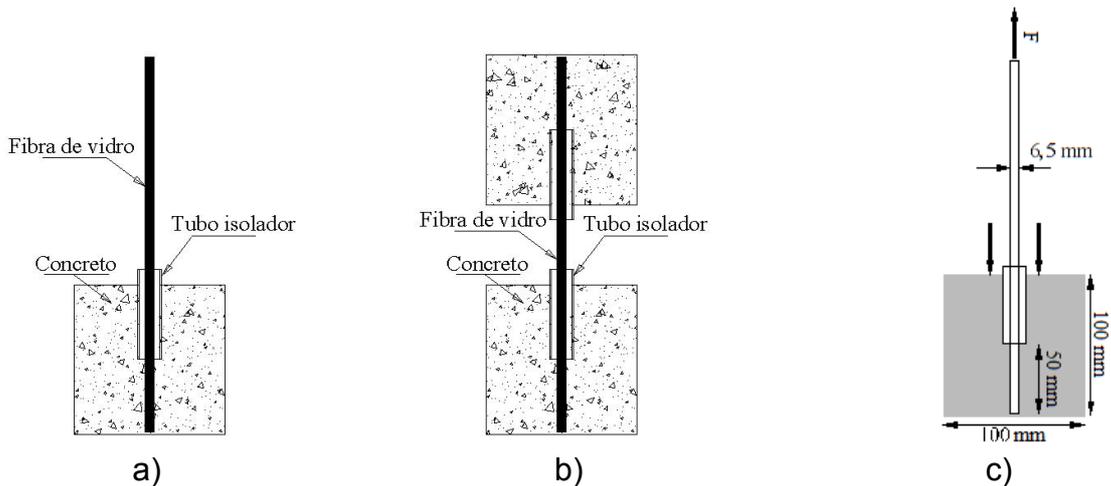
Detalhes dos arranjos para ensaio de arrancamento. a) bloco simples; b) bloco duplo; c) dimensões básicas utilizadas em ambos os arranjos.
